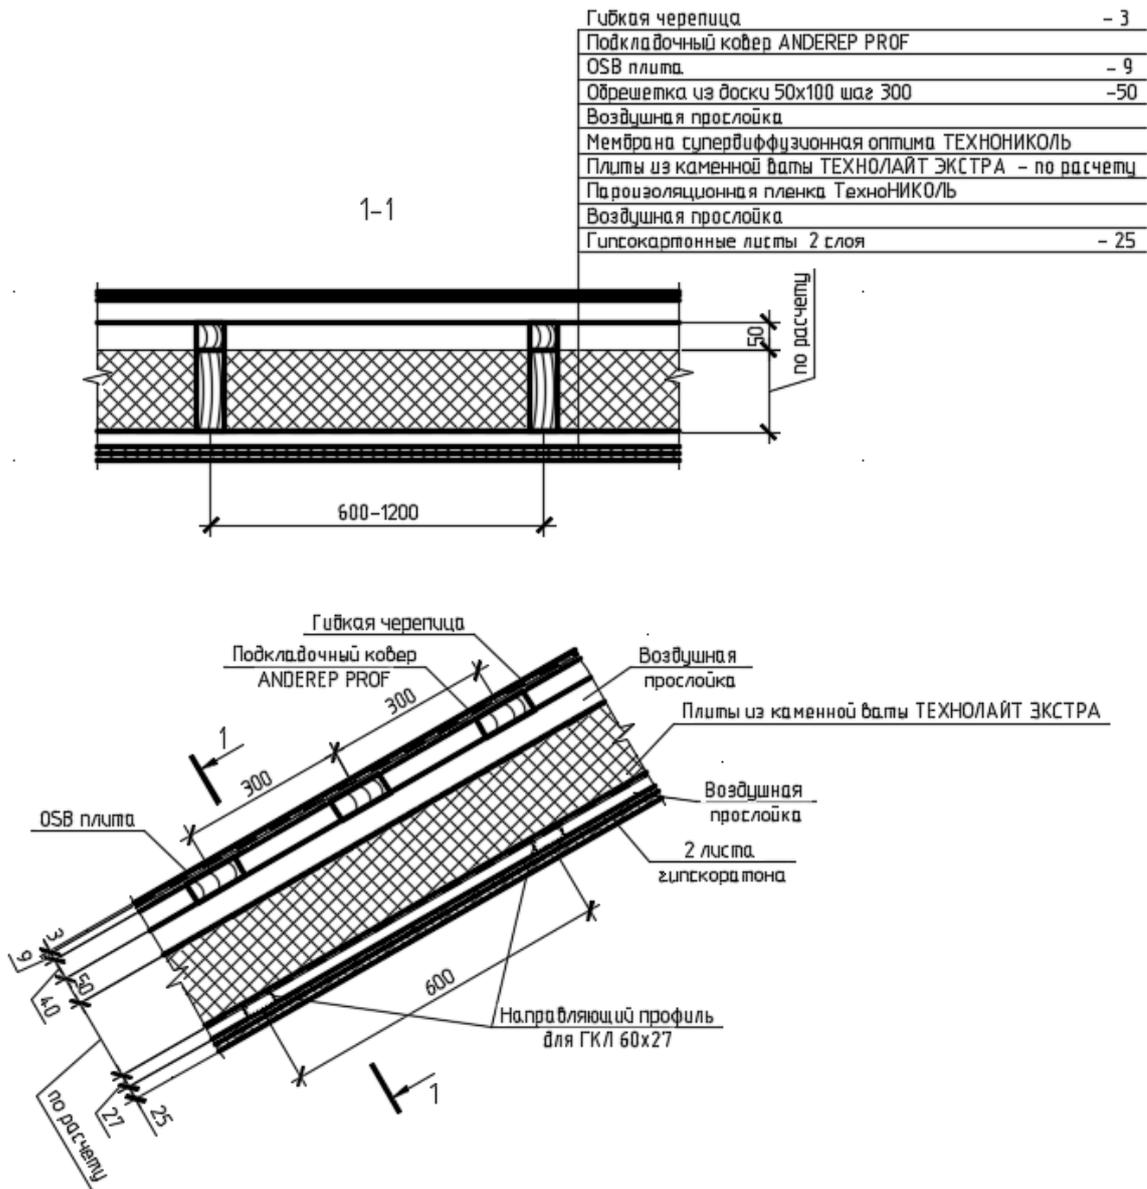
Пример решения утепленной кровли с покрытием из гибкой черепицы
